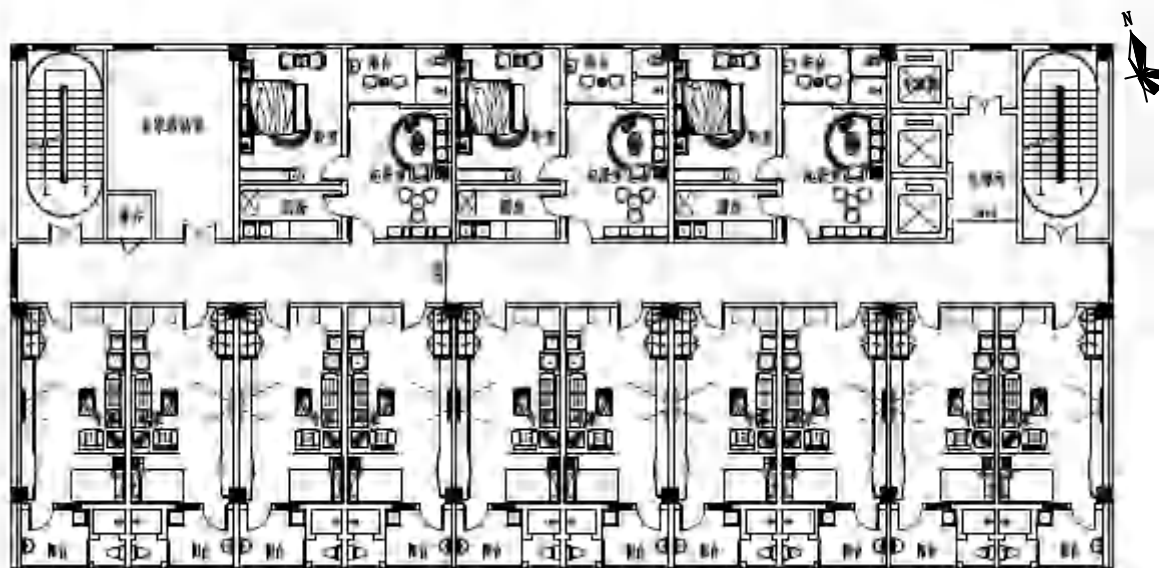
项目宿舍楼七层平面布置图（比例尺：1:297）
